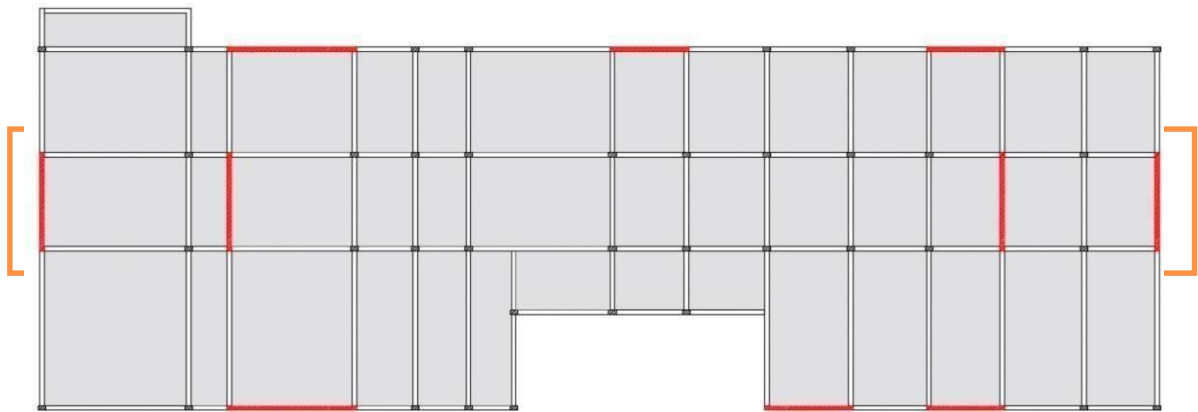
Techo 1° nivel – losa maciza – vista en planta.
